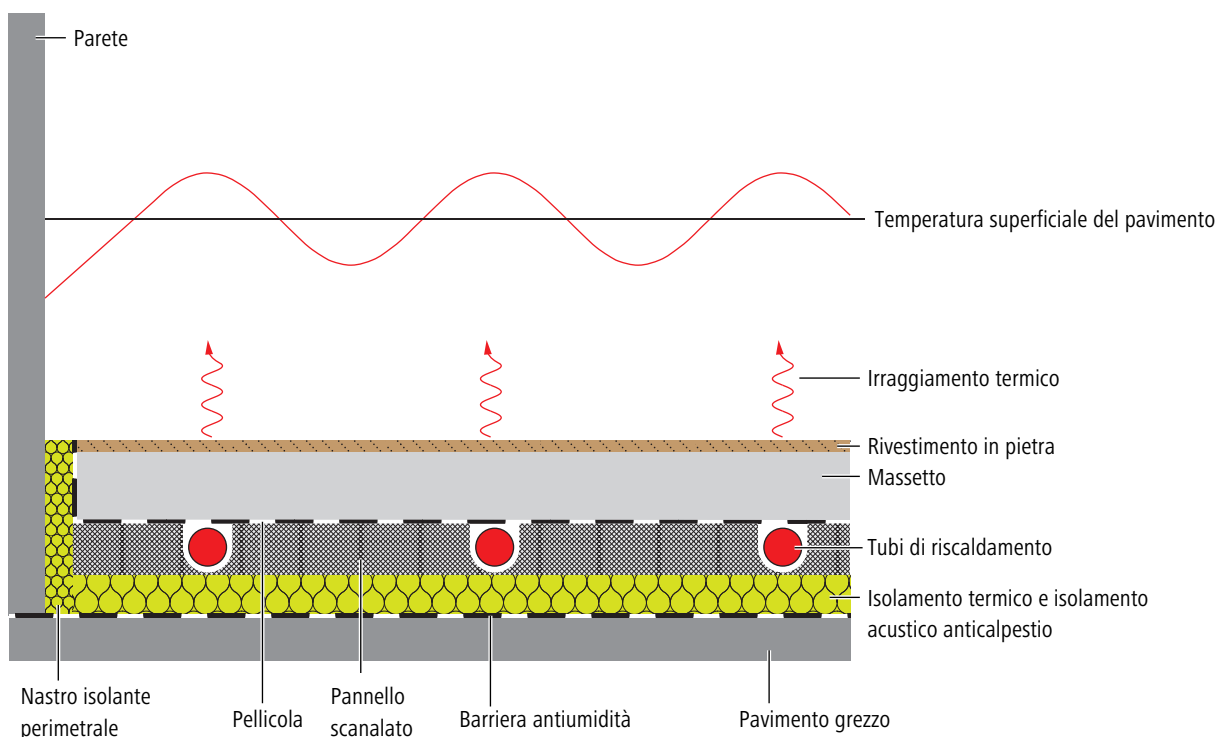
Posa a secco dell'impianto di riscaldamento a pavimento
